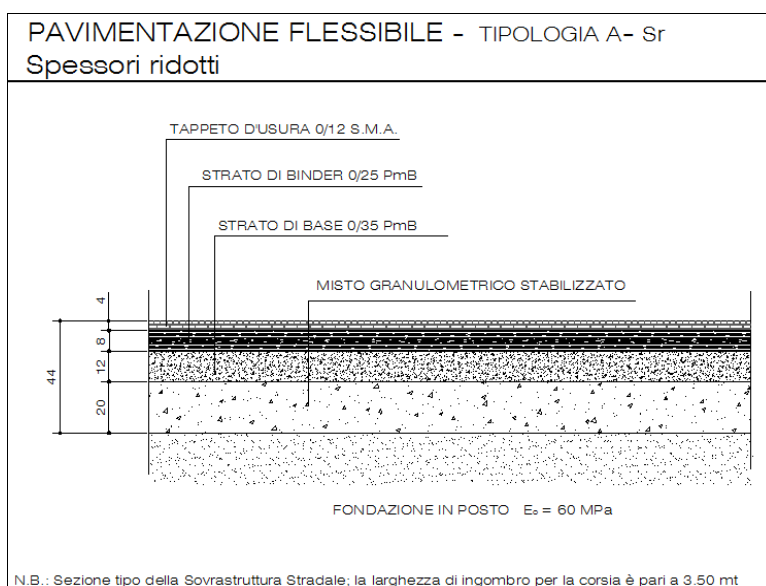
Pacchetto A-Sr per sottofondo con modulo < 300 MPa
